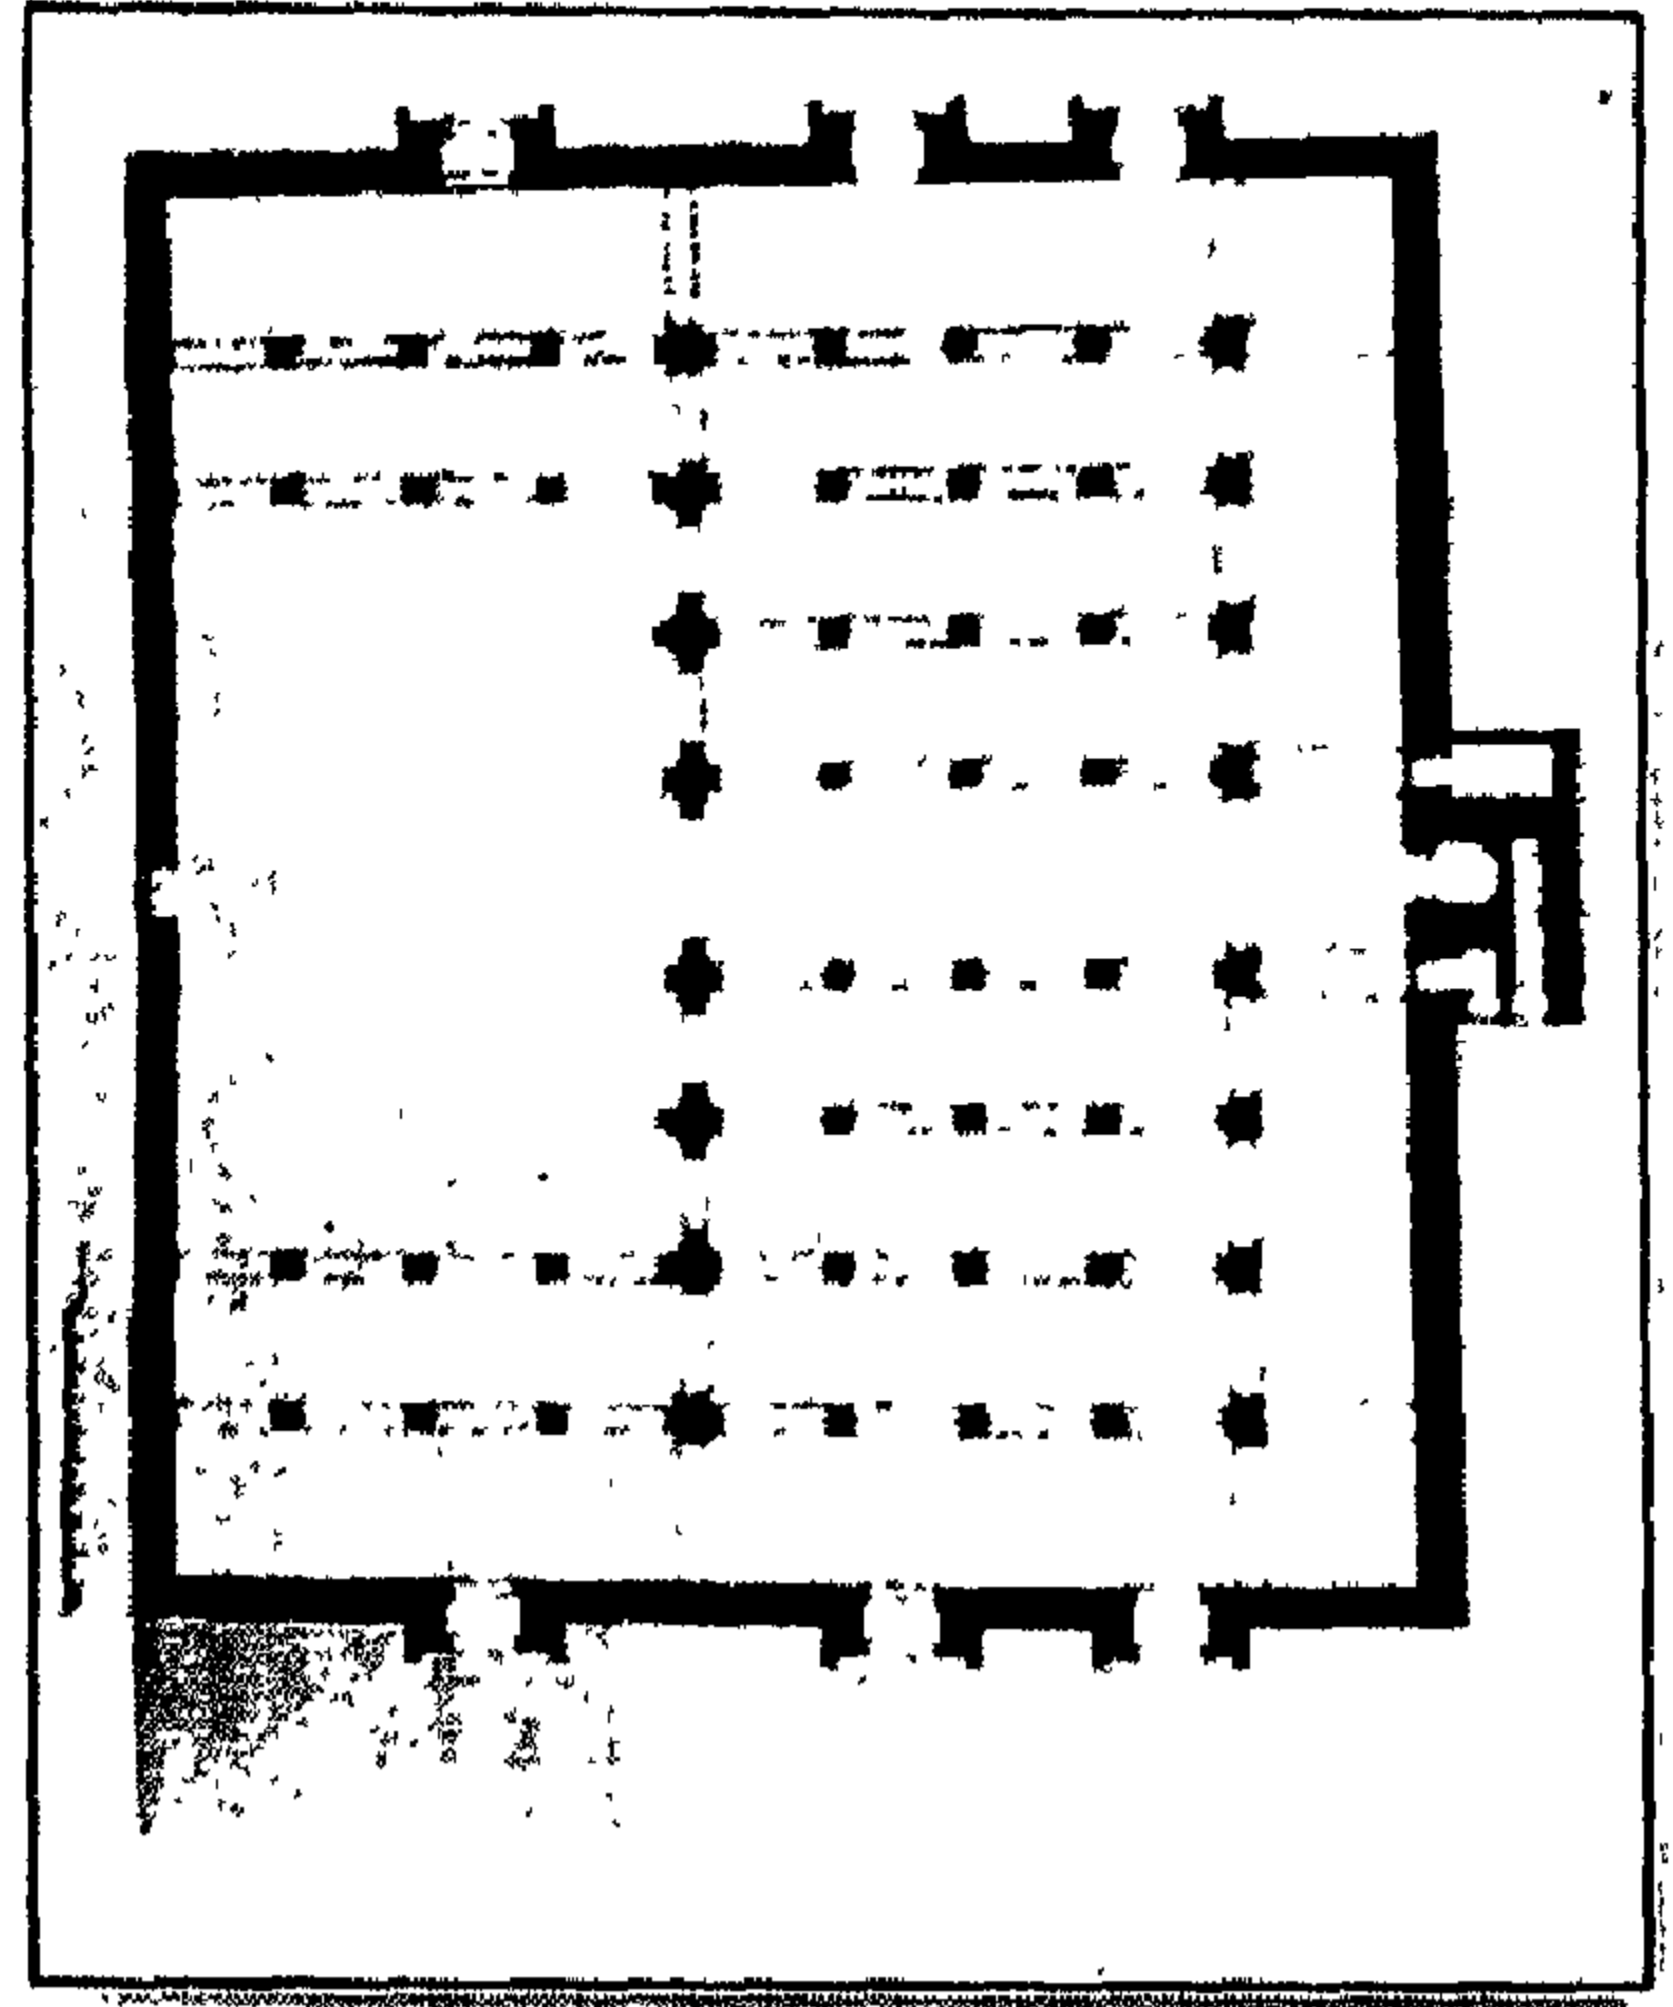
جامع القرويين بفاس (مسقط أفقي)
